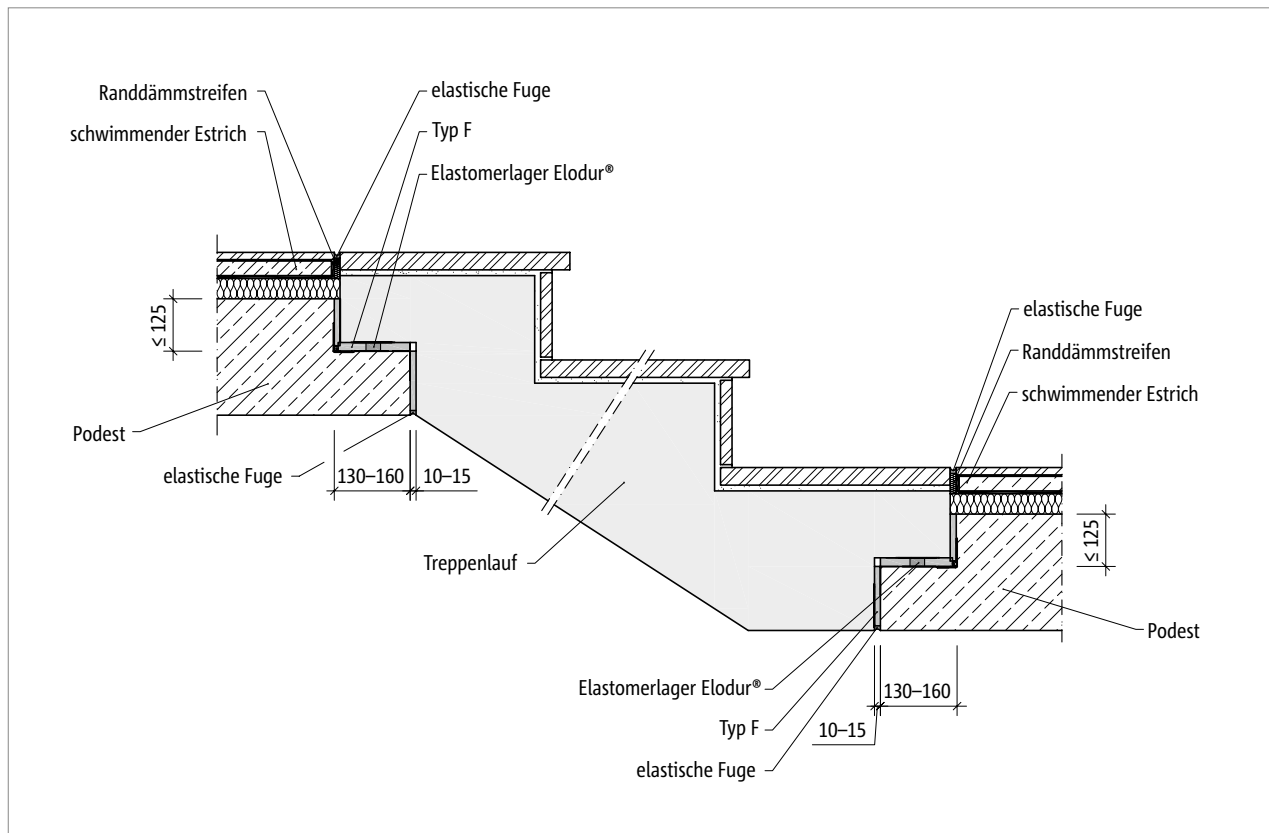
Schöck Tronsole® Typ F: Einbauschnitt
